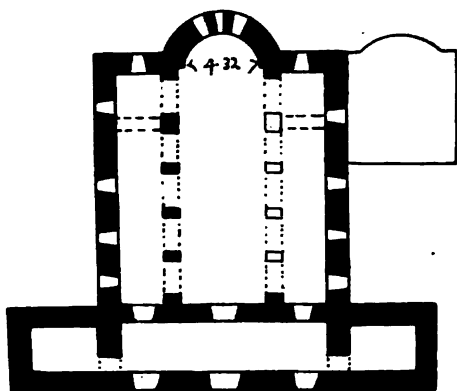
Binbirkilissé. Eglise n° 2. Plan (d'après Strzygowski, *Kleinasiën*).
